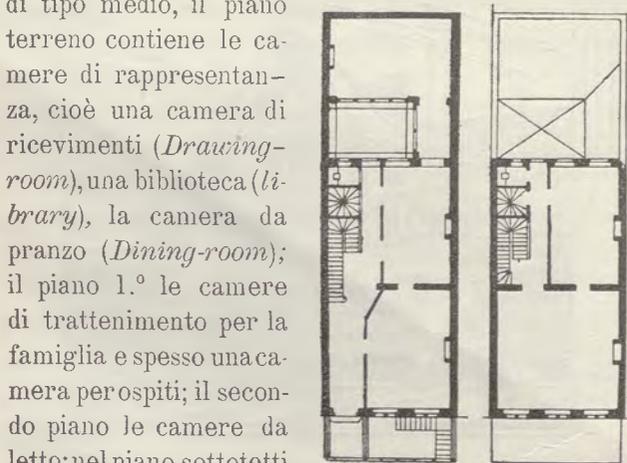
Pianta di *cottage* inglese. (Scala 1:500).
